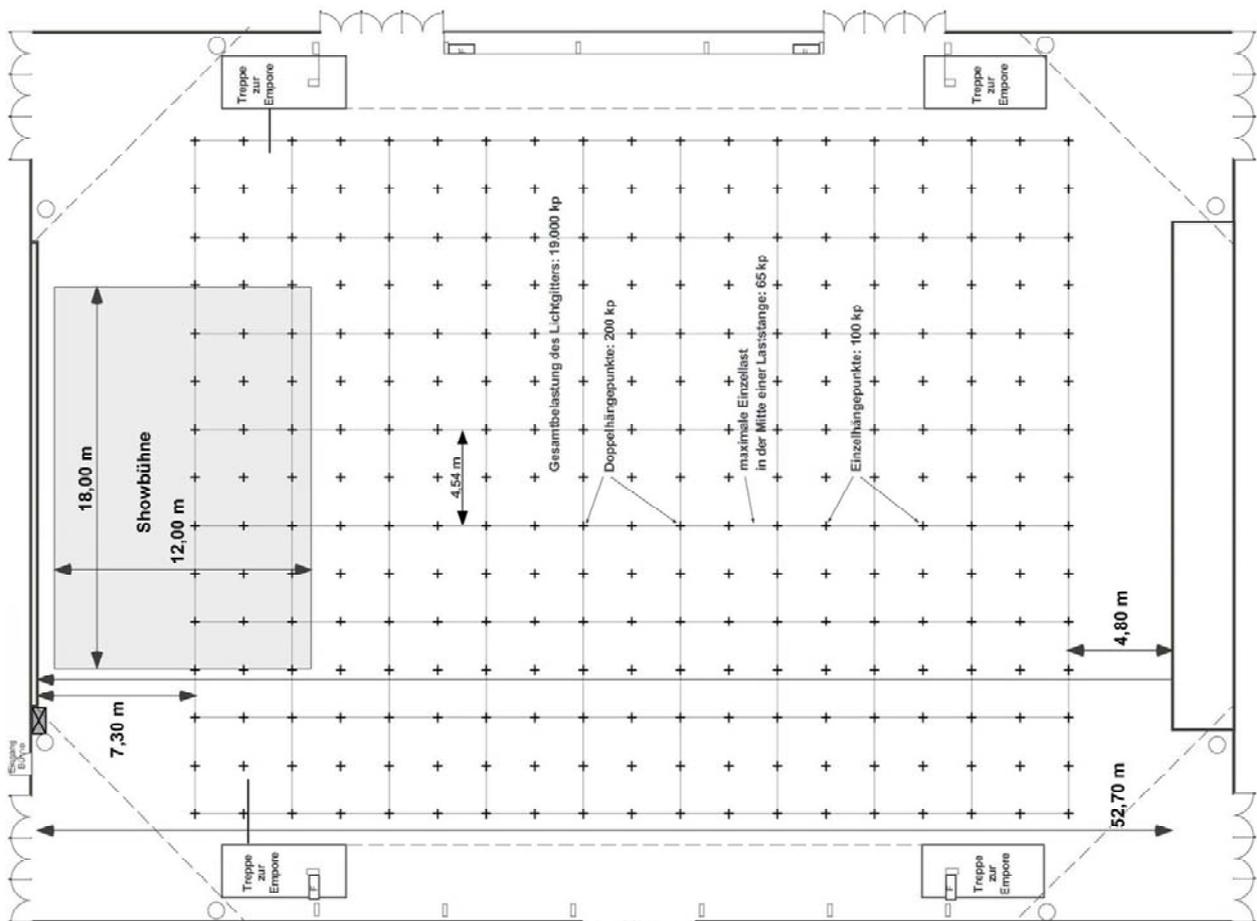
Dachplan mit Lichtgitter, Hängepunkten und Lastangaben
